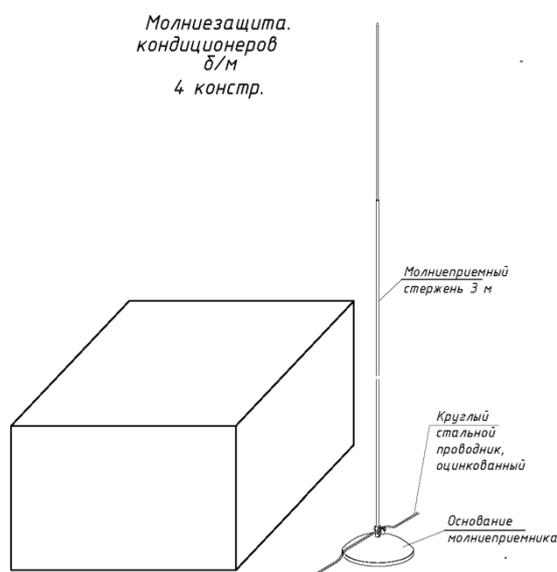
Установка молниезащитного стержня на кровле здания
